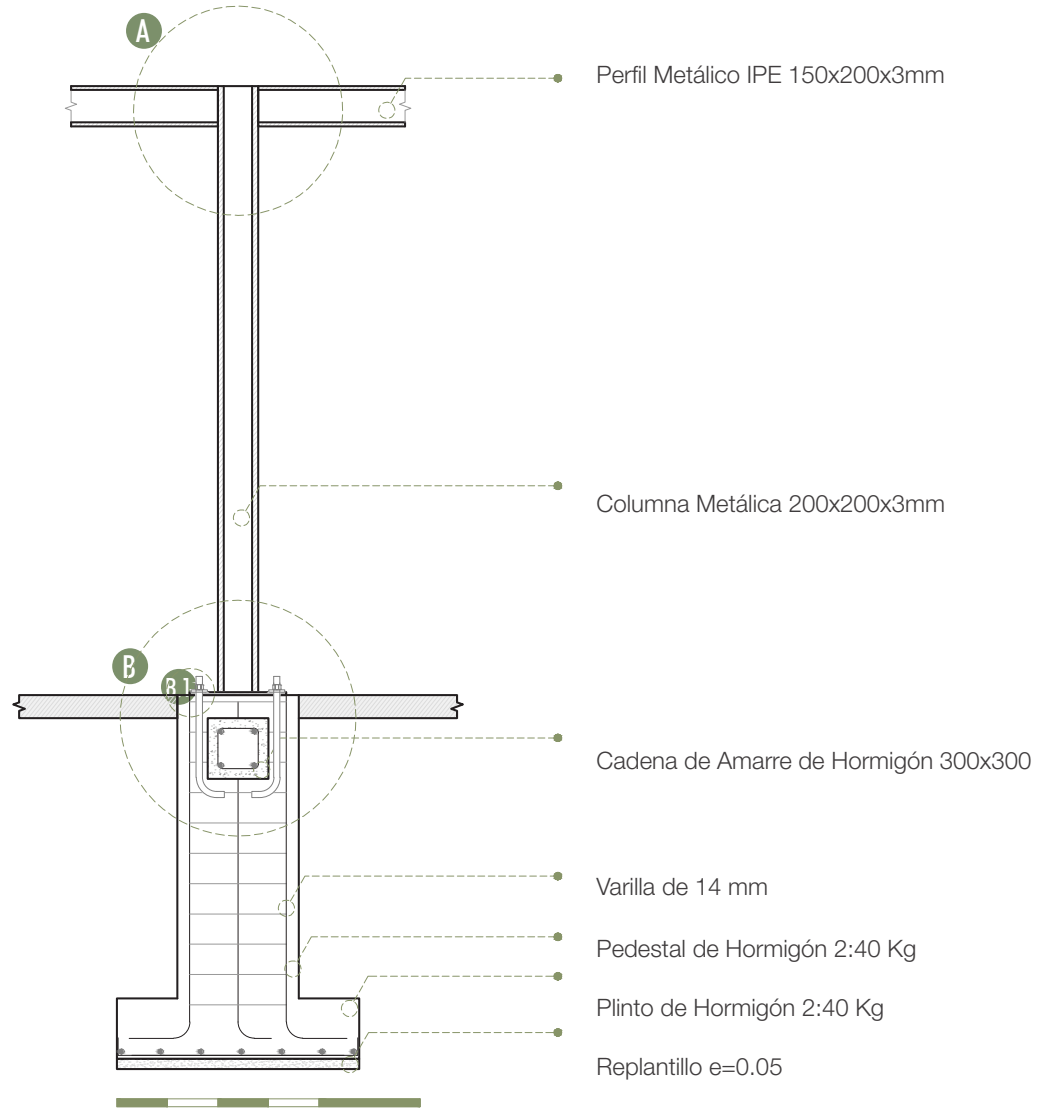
Sección de Corte por Fachada - Laboratorios Urbanos
